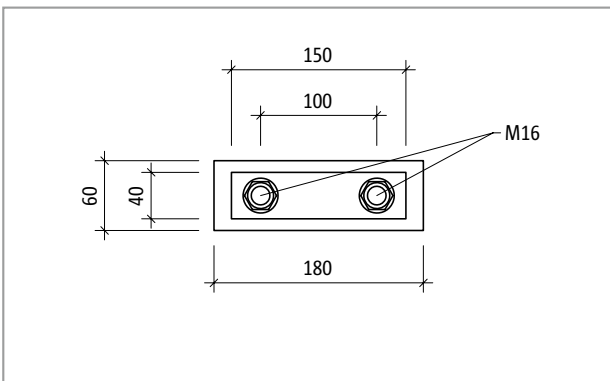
Schöck Isokorb® T type S-N-D16: Elevation of the product
